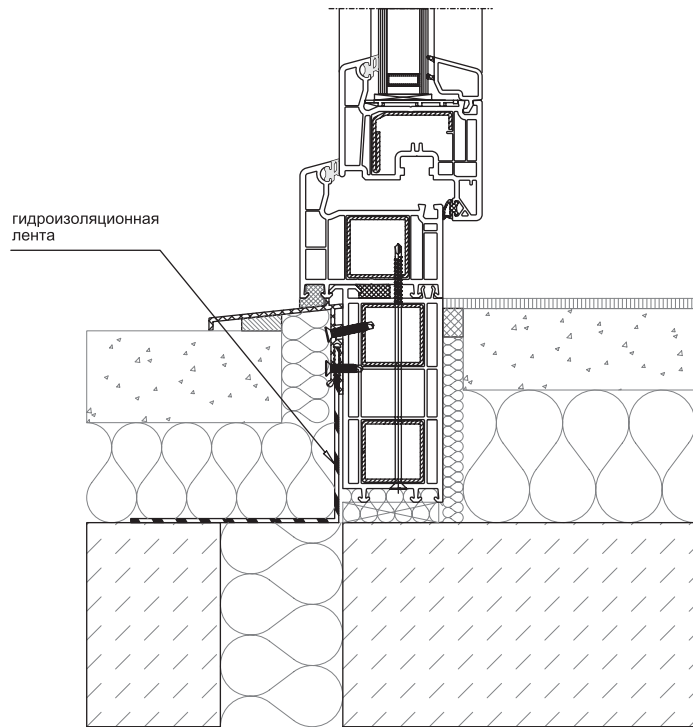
Использование гидроизоляционного полотна в конструкции порога
